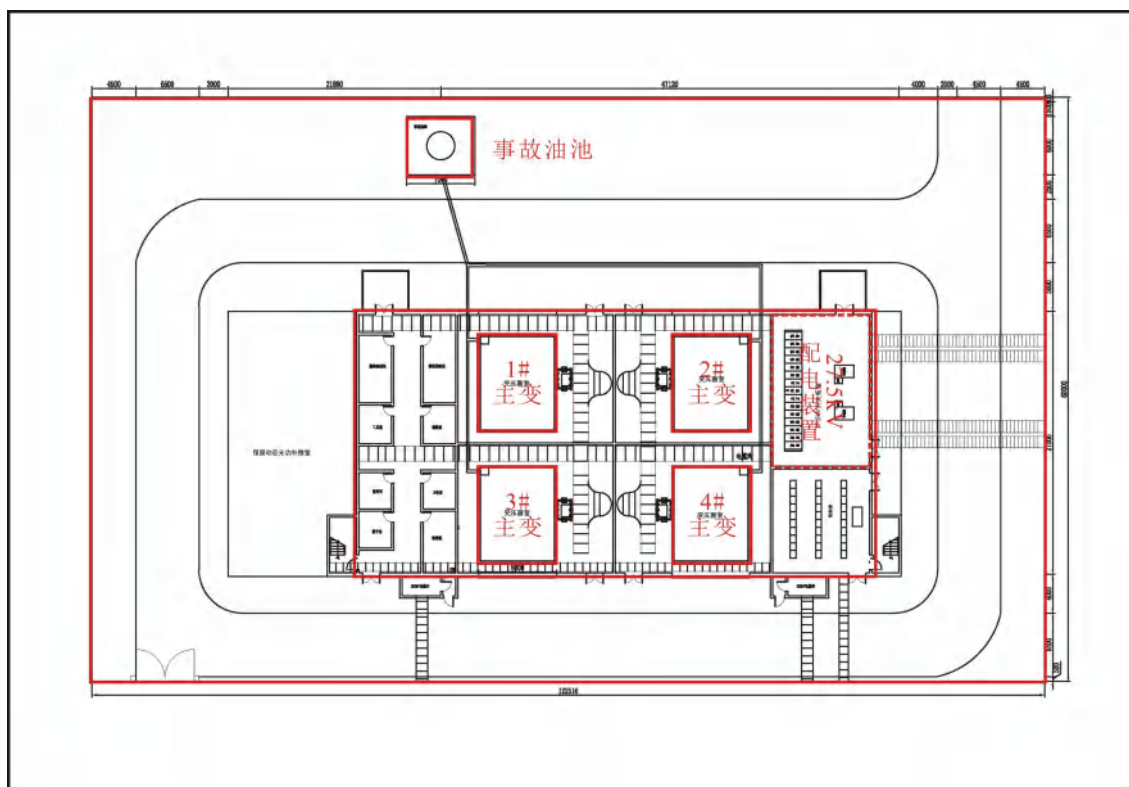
220kV 义南牵引变电所总平面布置图（户内变电所）
